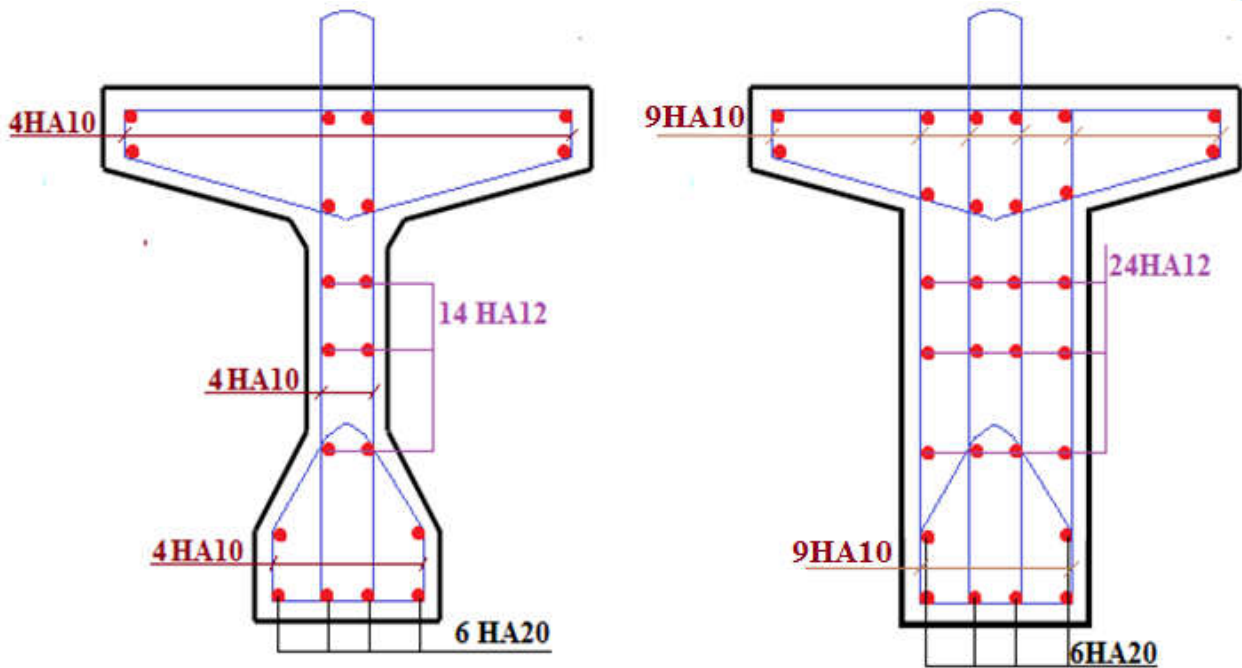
Ferrailage de la poutre pour bonde de 1 m.
